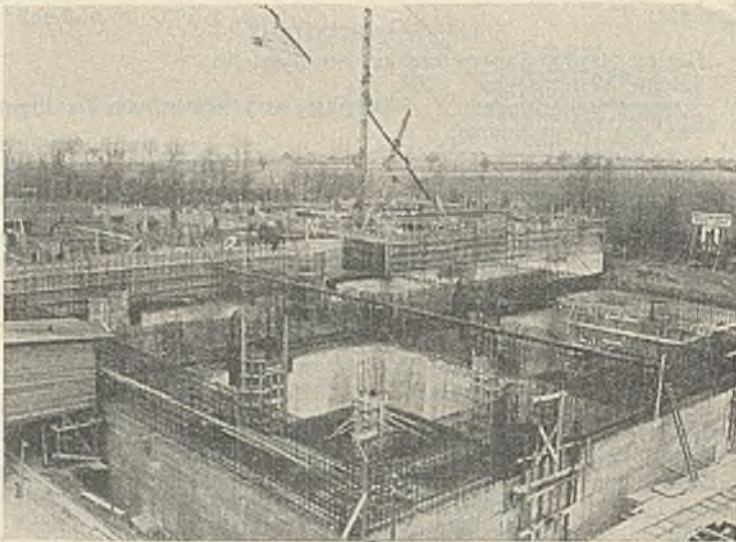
Wandbewehrung des Hauptfaulbehälters.
